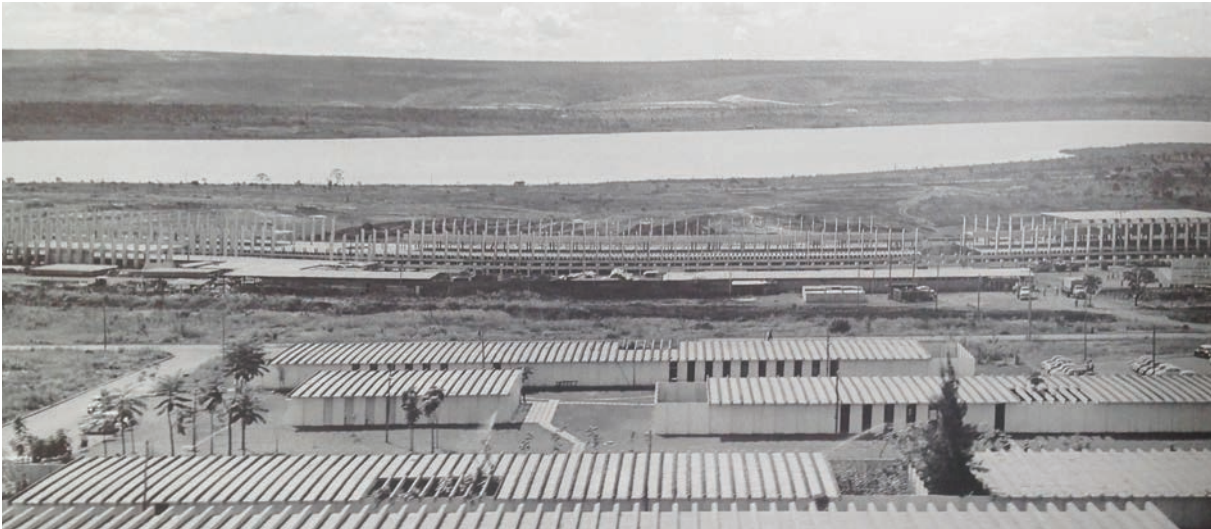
Fotografia do conjunto de edifícios da UnB e do CEPLAN em 1962; ao fundo o ICC em construção, sistema seriado, com a repetição de elementos estruturais pré-moldados no canteiro. Fonte: WESLEY, 2010
